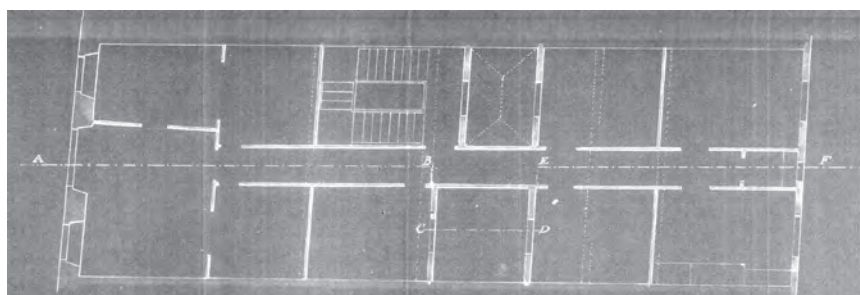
18. 1913 PRIMERA Y SEGUNDA PLANTA⁵
